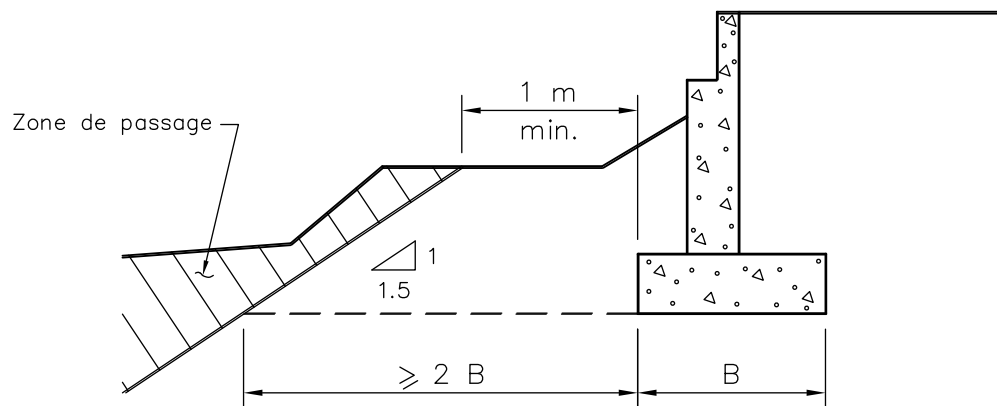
Zone de passage d'un conduit ou d'un groupe de conduits à l'avant d'une culée
